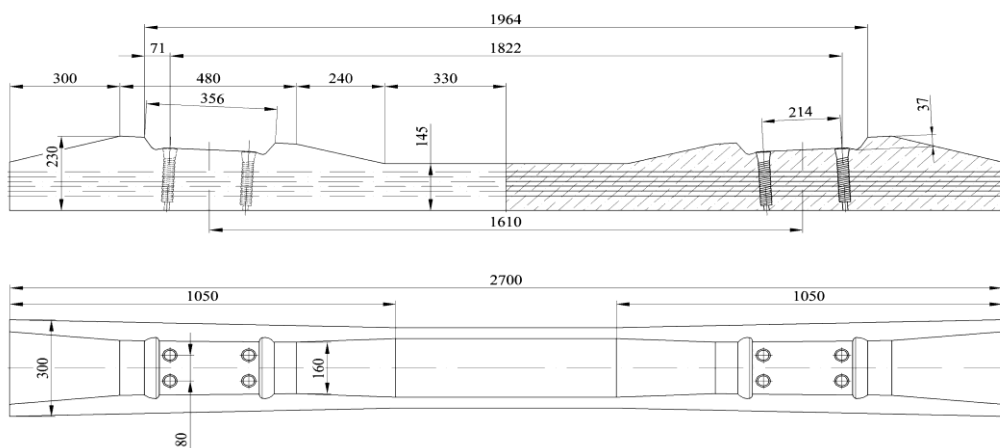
Залізобетонна шпала типу Ш7
